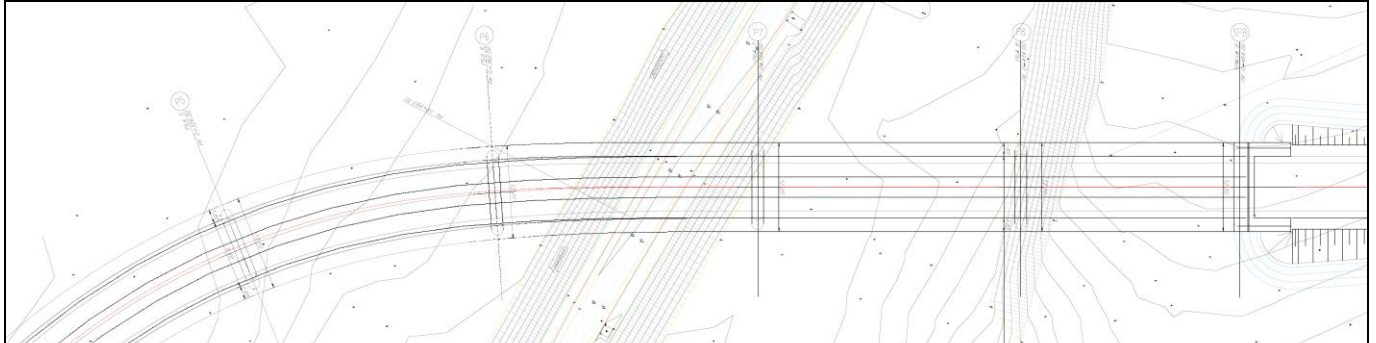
Pianta Impalcato Cavalcaferrovia IV01 km 18+993 (Tav. 2) (Rif.: [62])
